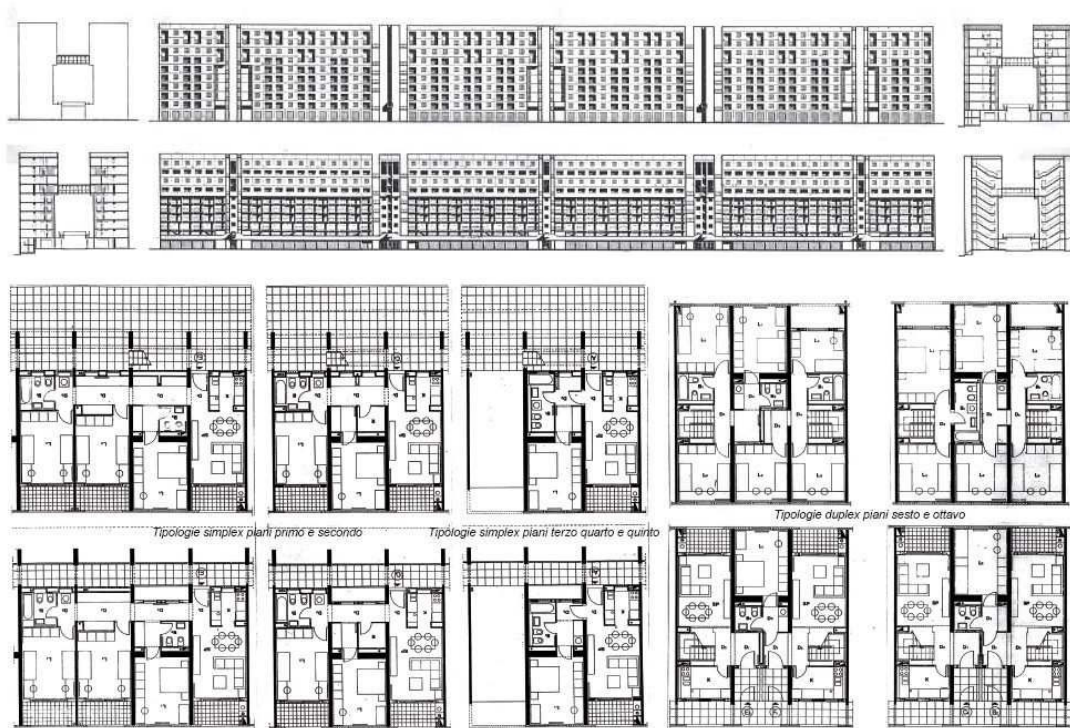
Pianta tipo e prospetti dell'edilizia alta di taverna del Ferro
